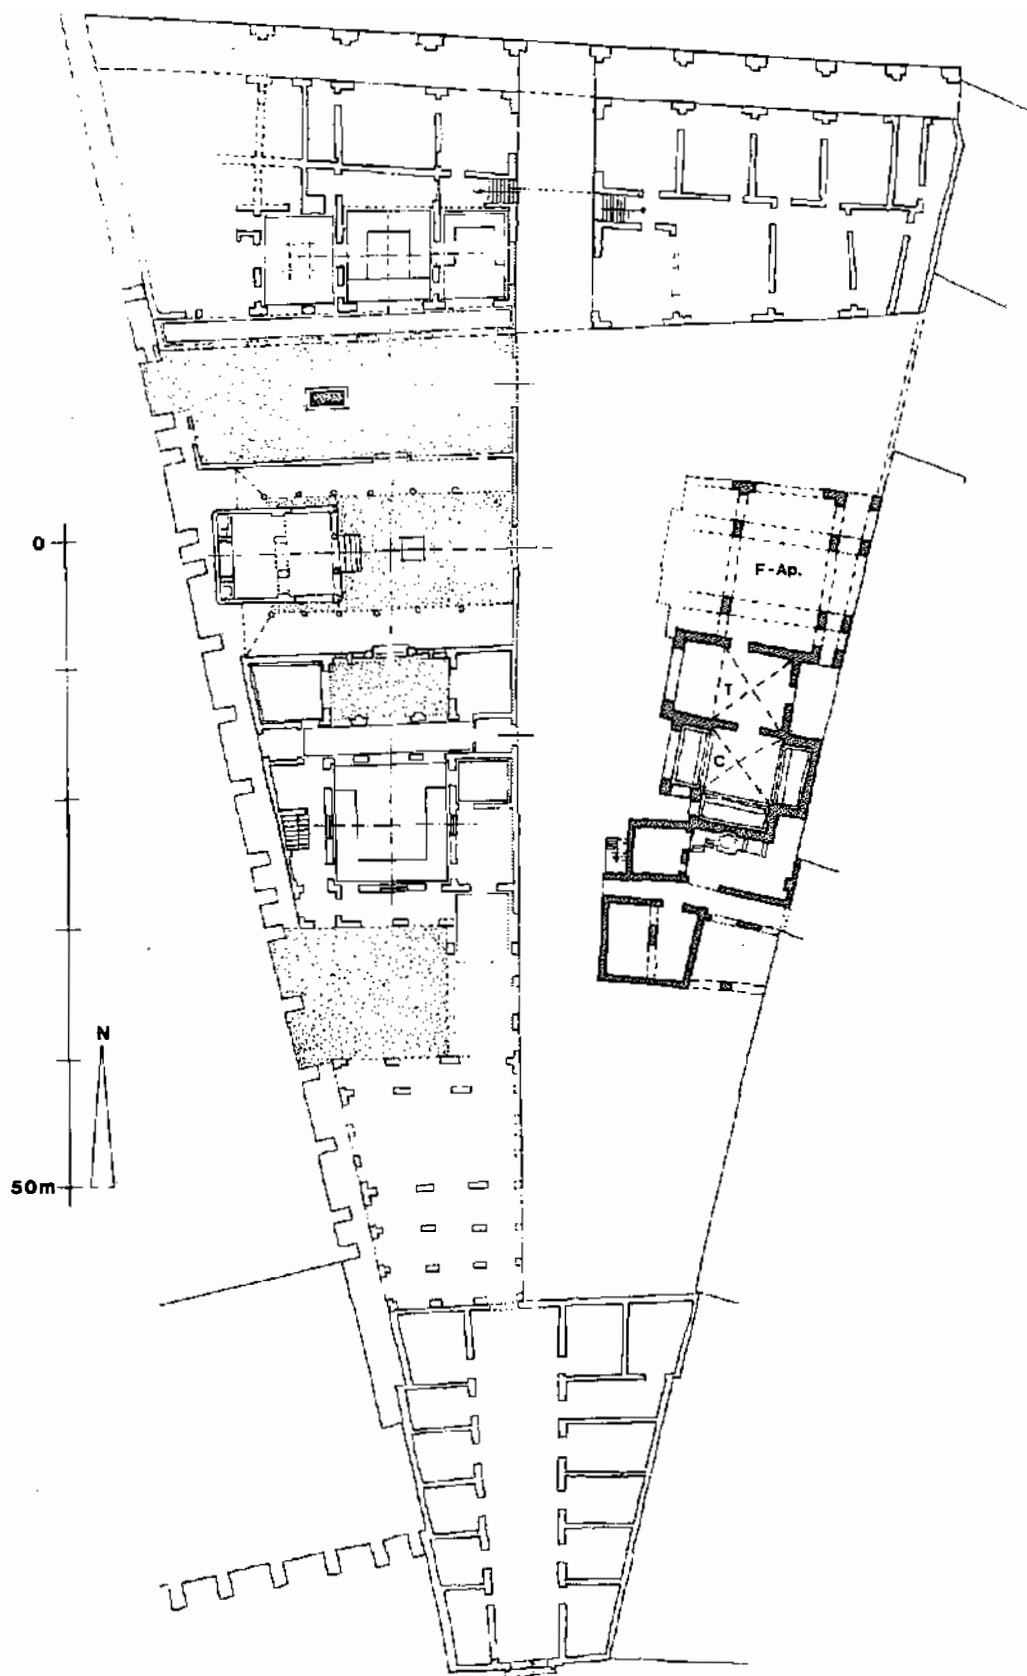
Planta de la primera fase del Serapeo con la posición del Casggiato di Baccho e Arianna y las termas de la Trinacria (en negro). En ambos se ha reconstruído su planta inicial.
